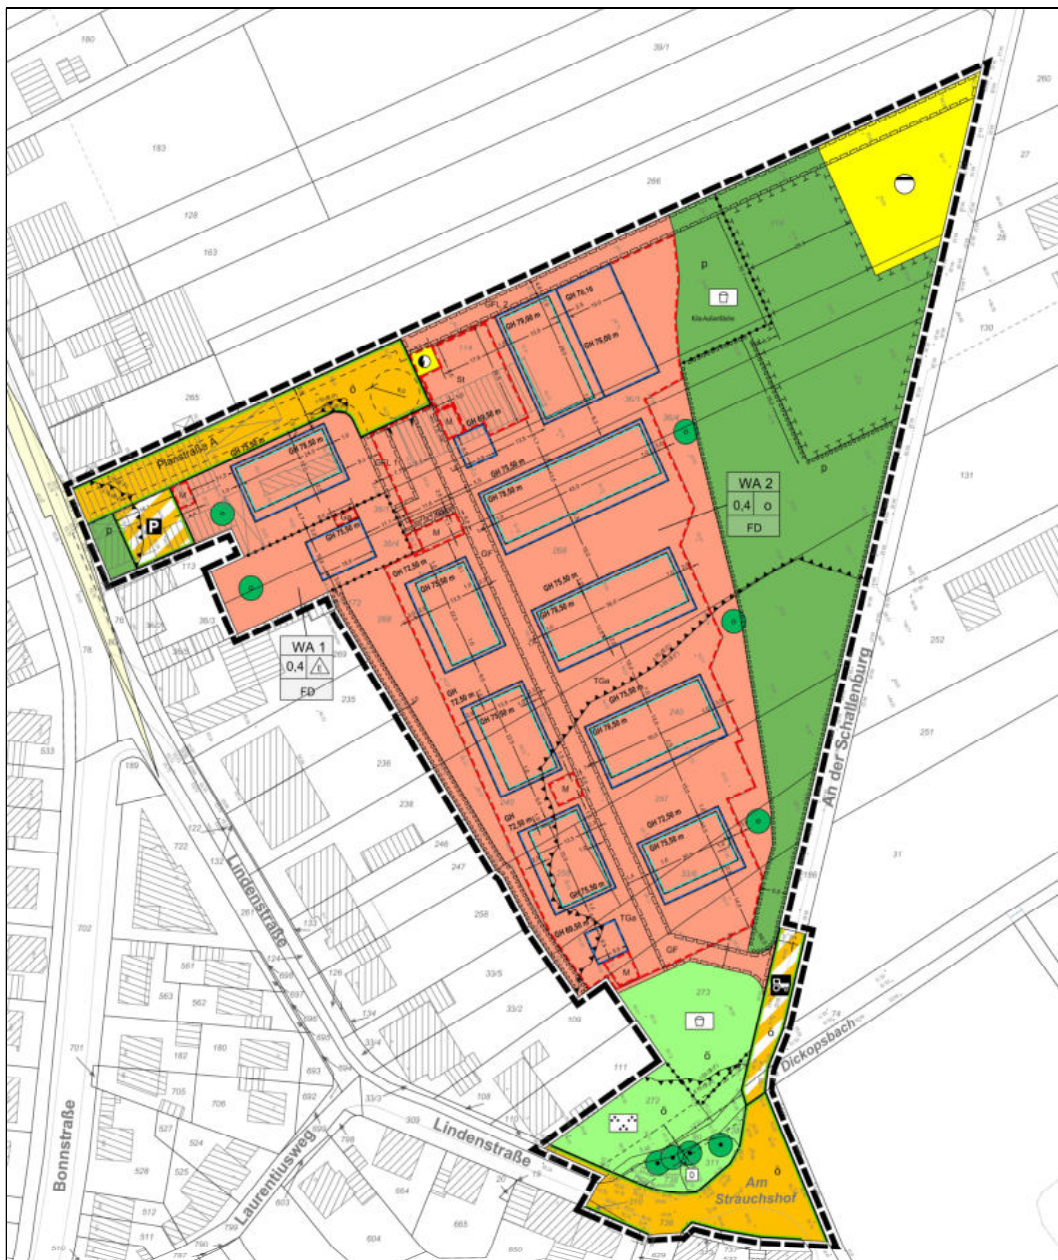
Bebauungsplanentwurf 05.10 (06/2025)
